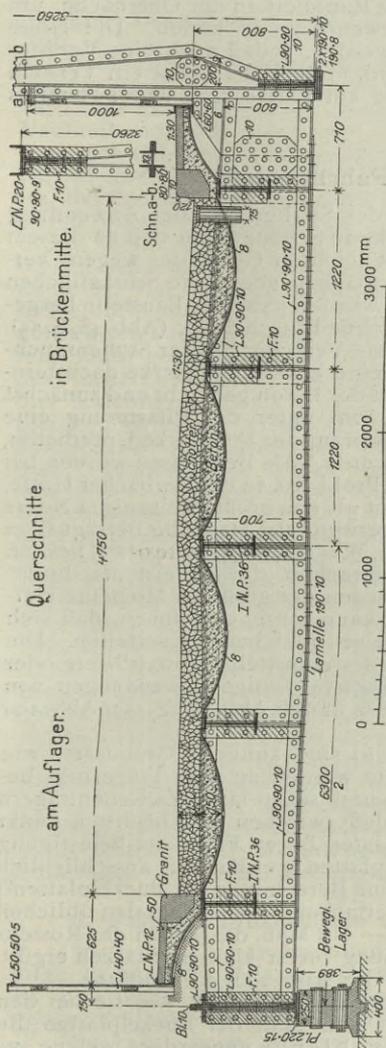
Querschnitt durch eine Straßenbrücke mit Schotterbahn.
